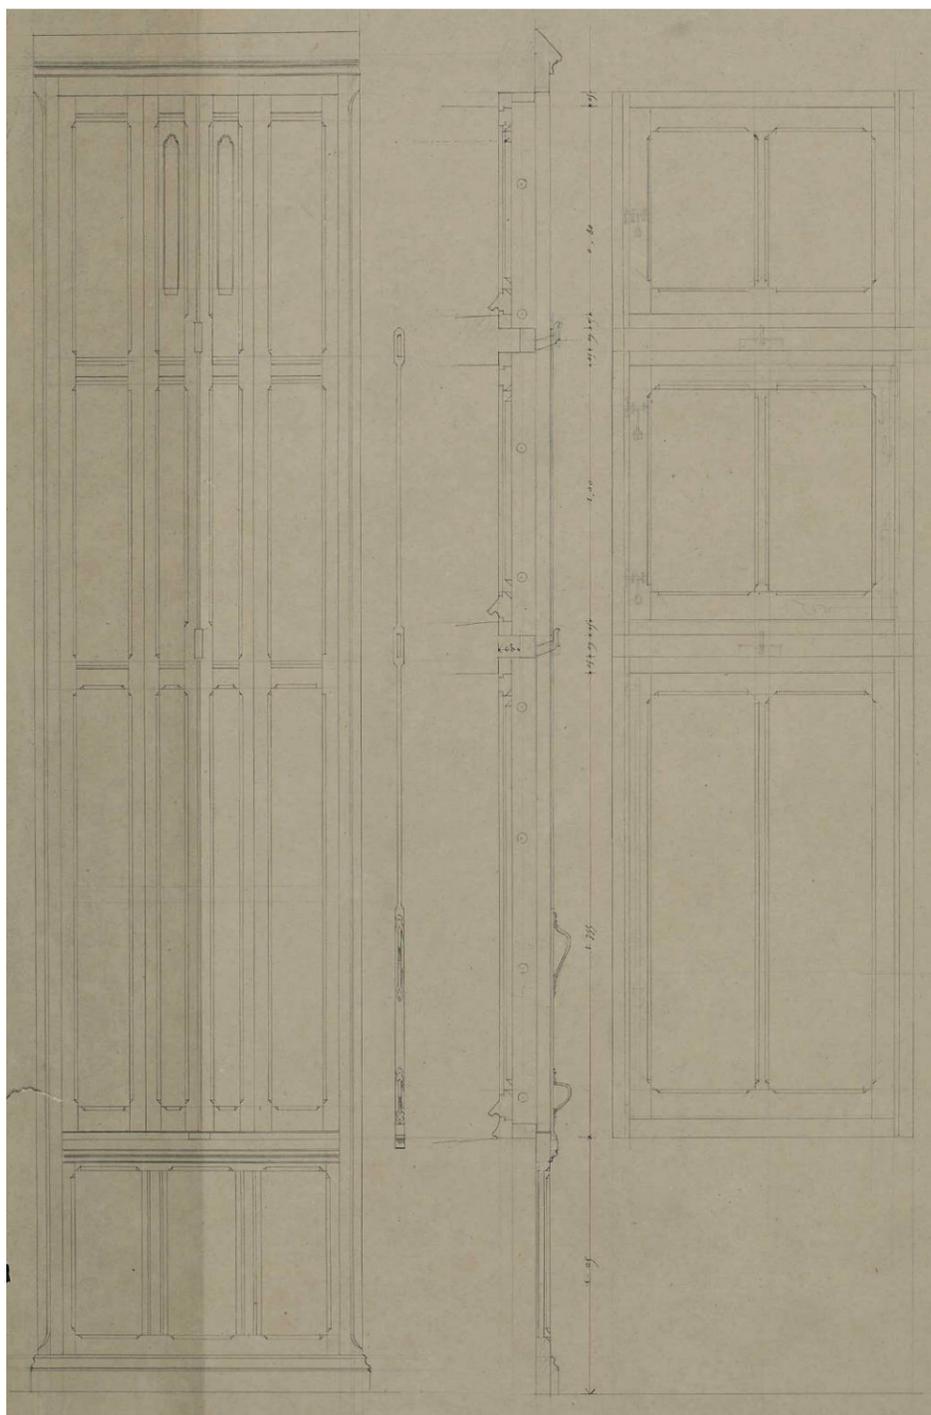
Pierrefonds, château – Détail d'un dessin de Viollet-le-Duc pour la restauration d'une grande croisée à deux croisillons (plan non localisé).
